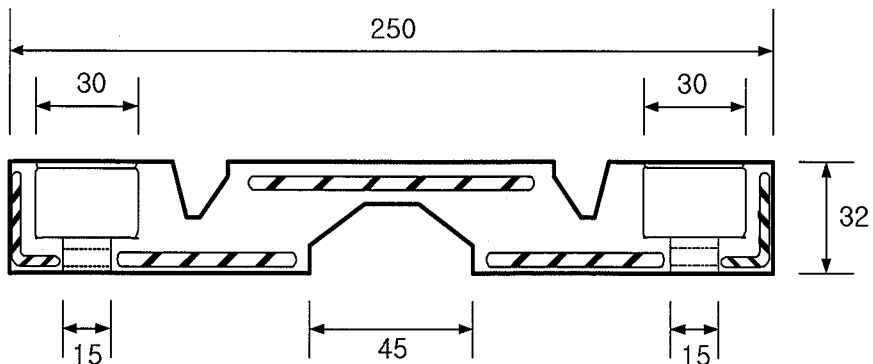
Transflex Joint의 단면도 (단위 : mm)
